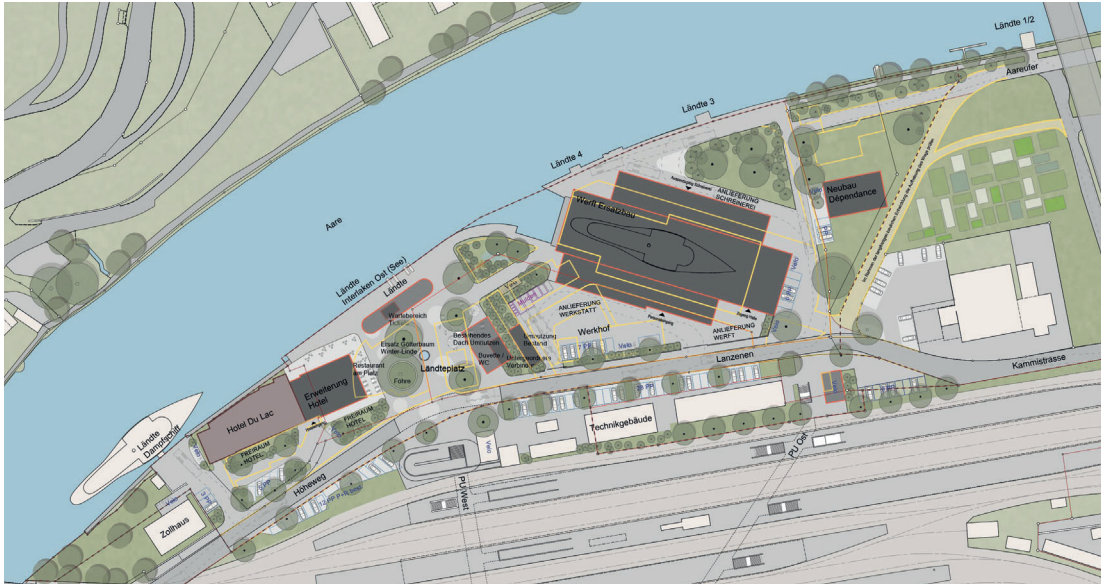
Städtebauliche Gesamtsituation im Situationsplan, Option A: Erhalt bestehende Bauten Ländteplatz
